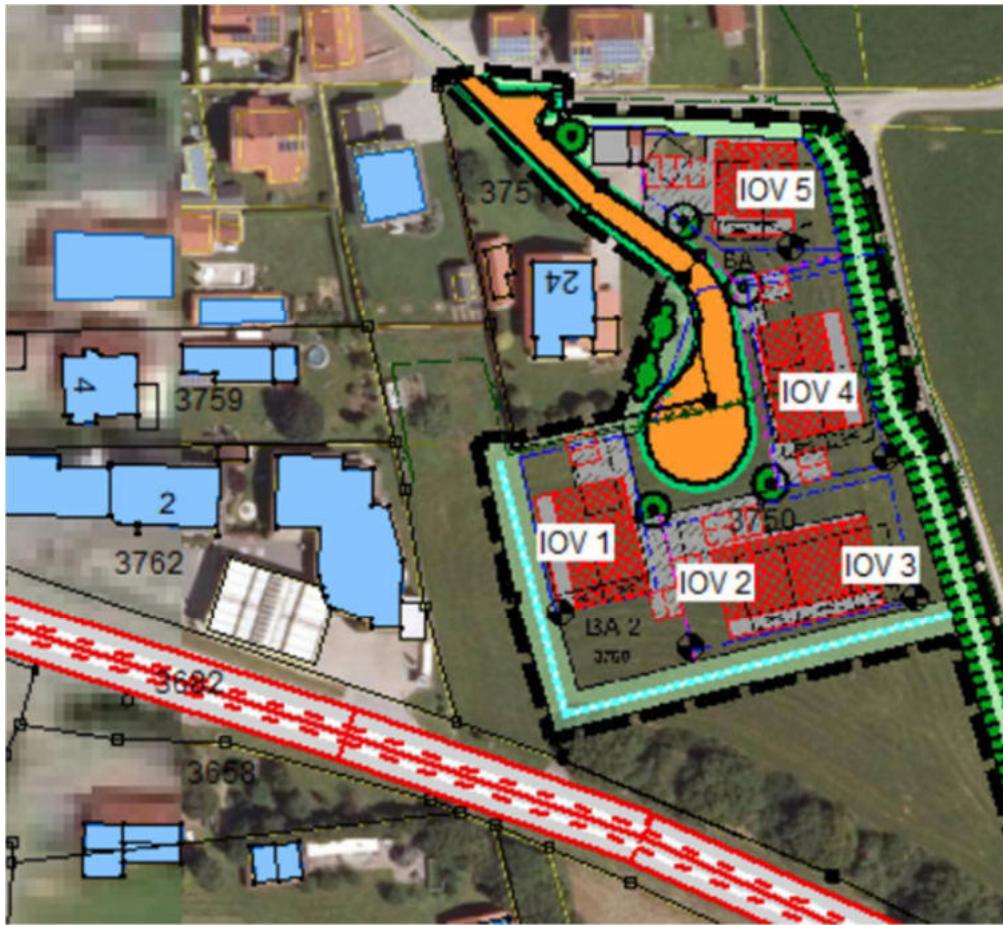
Lageplan mit Kennzeichnung Immissionsorte IOV 1 - IOV 5, Verkehrslärm
